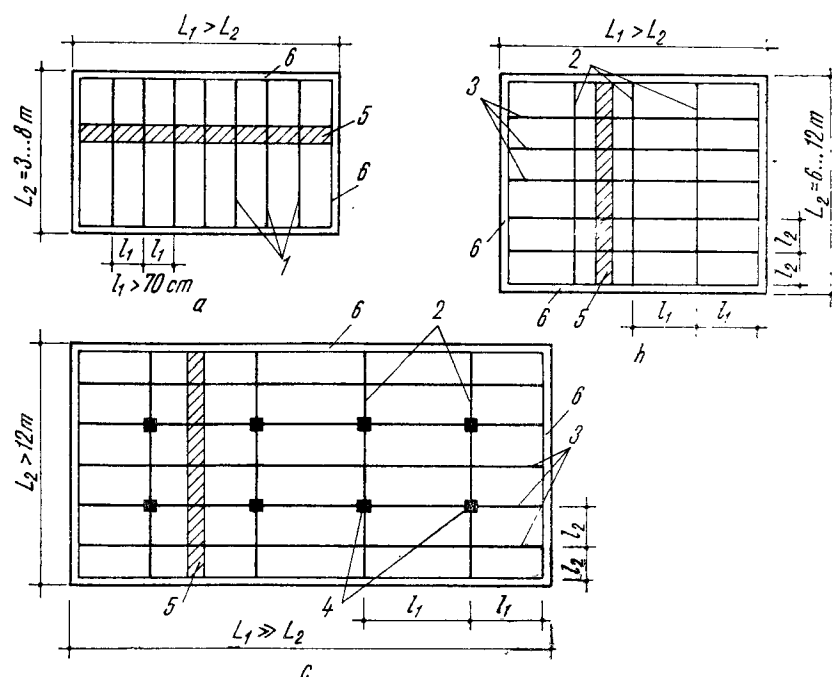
Planșee din plăci și grinzi, schemă în plan :
